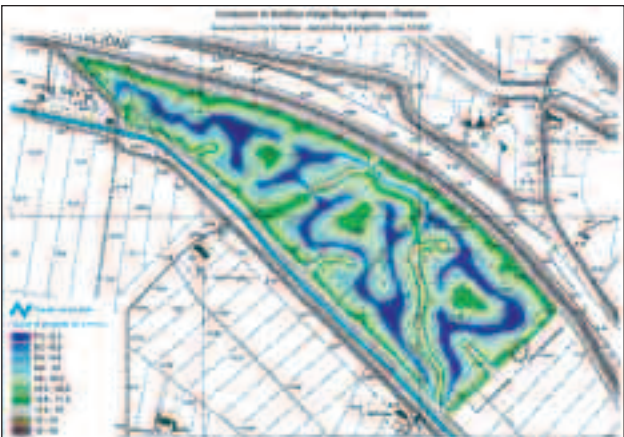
Planimetria dell’area di Ca’ di Mezzo.
